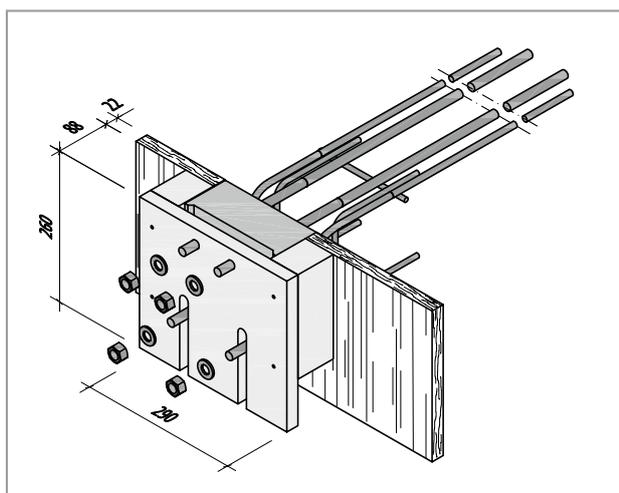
Schöck Isokorb® T tipo SK: Ilustración con plantilla de montaje
